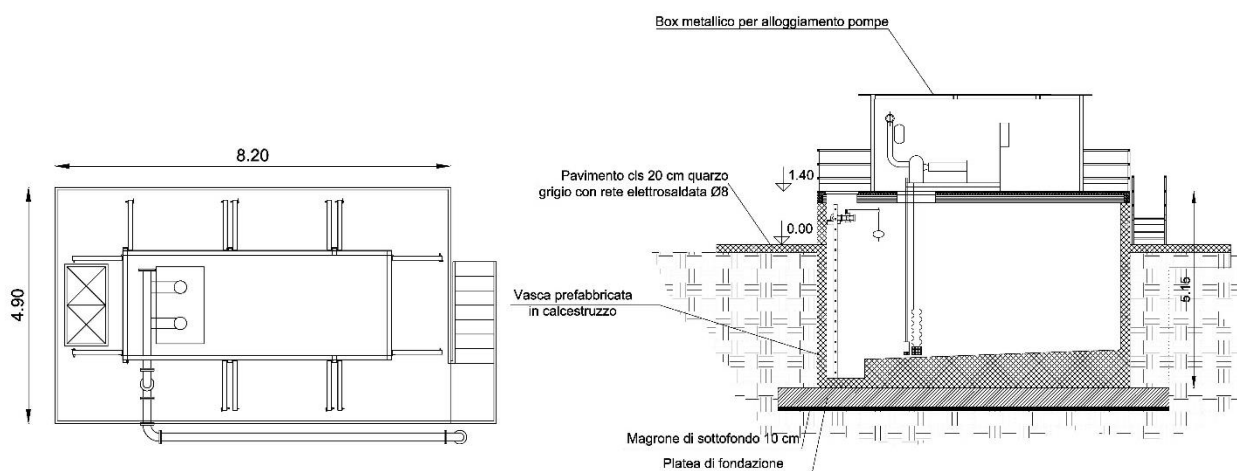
Vista in pianta (a sinistra) e in sezione (a destra) vasca antincendio
